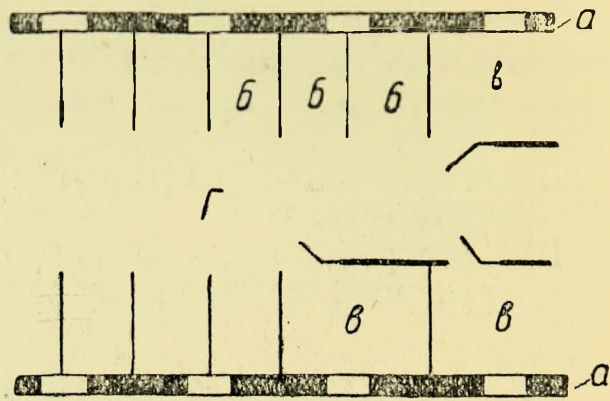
План двухрядной конюшни с размещением лошадей головами к наружным стенам: а — наружные стены; б — стойла; в — денники; г — навозно-кормовой коридор; з — выходы из денников.
